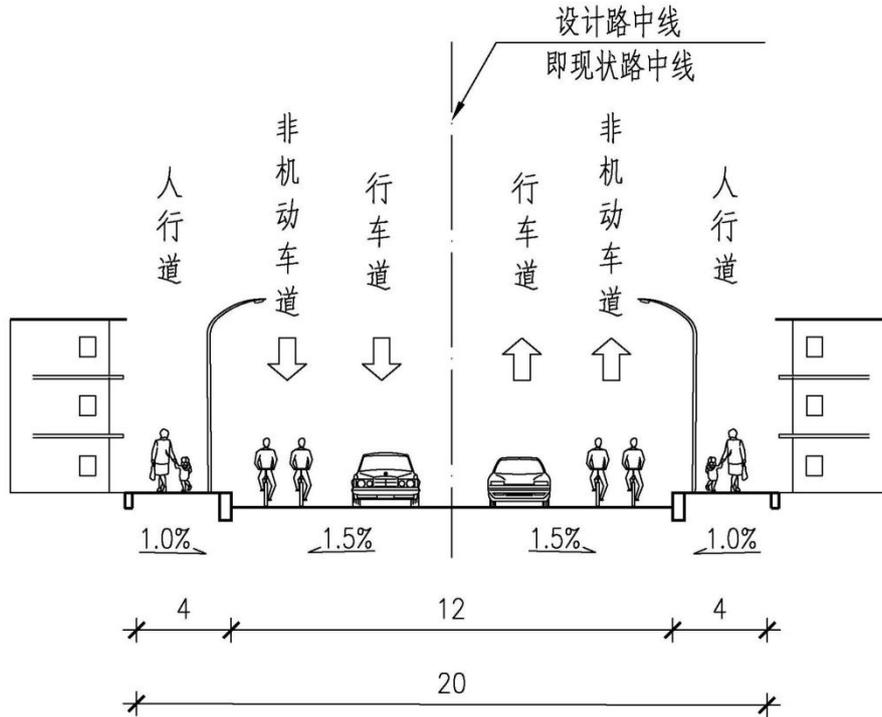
勤俭支道（丁字沽零号路~勤俭道）设计横断面图
